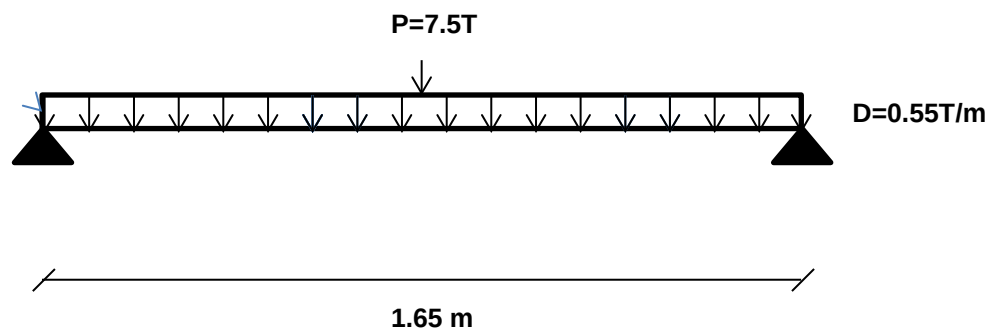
Esquema simplificado de la acción de la carga viva y muerta sobre la losa entre vigas.
